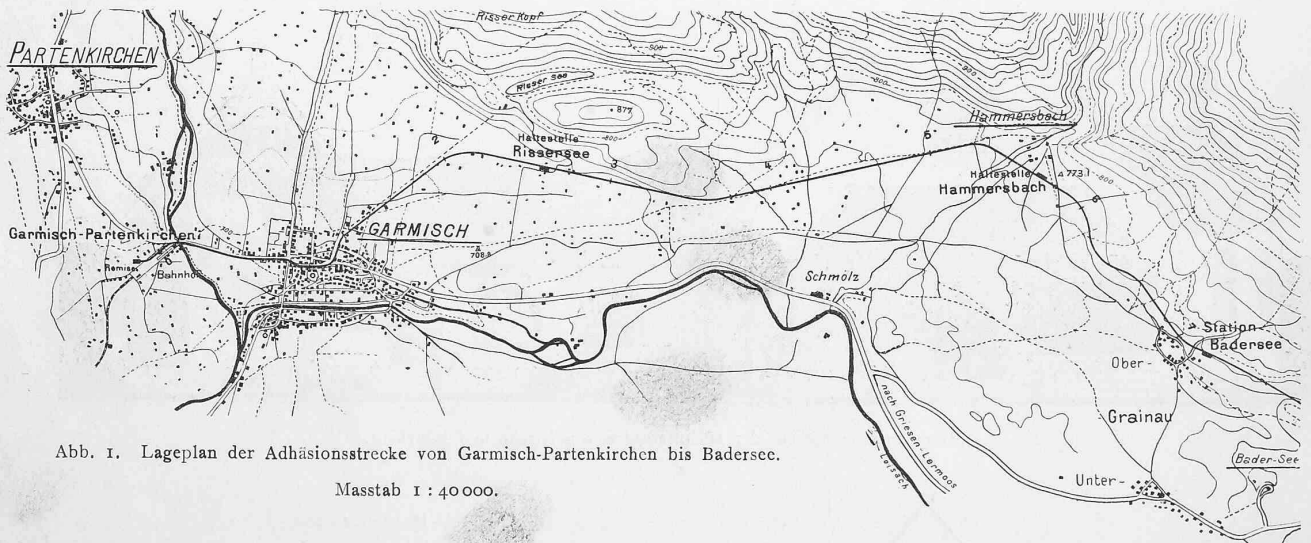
Lageplan der Adhäsionsstrecke von Garmisch-Partenkirchen bis Badersee.
